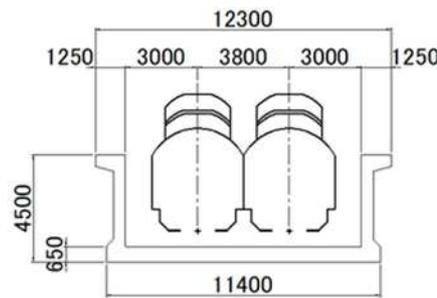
試算用 PRC 下路桁一般図 (一般部断面)
